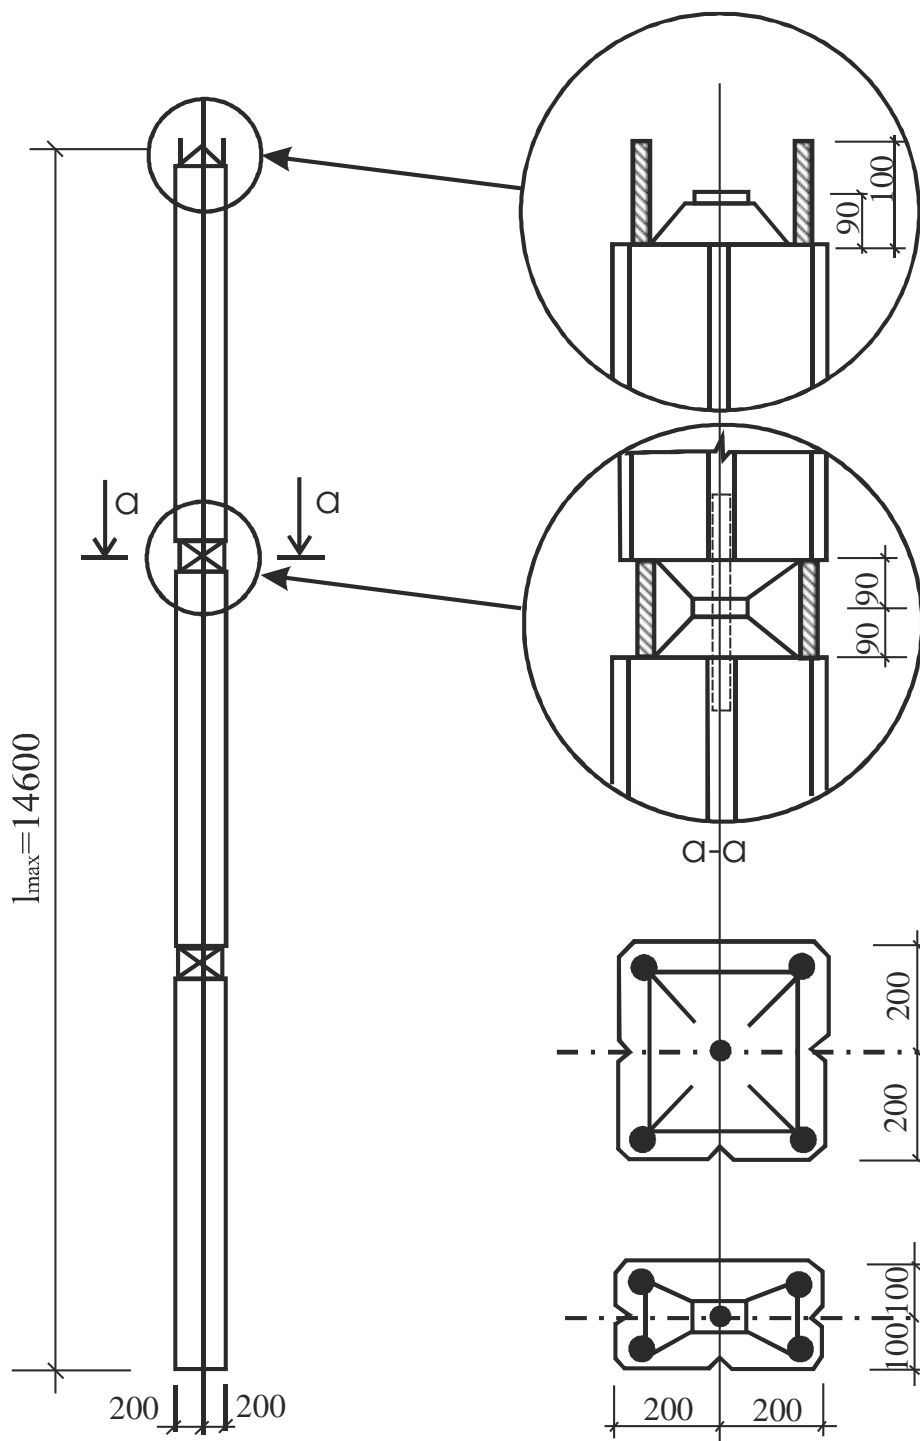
Колонны безригельного каркаса «Куб-2.5»
